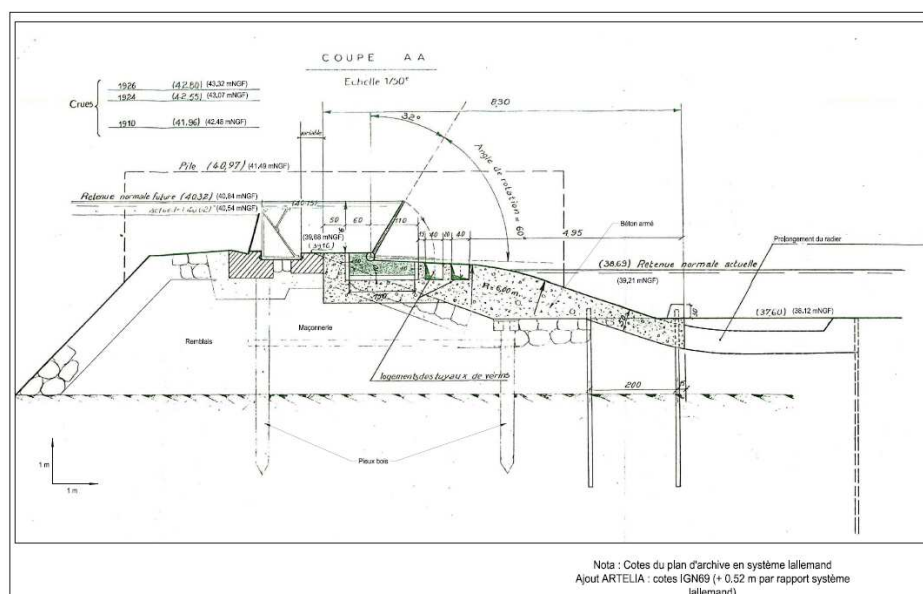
Coupe sur déversoir pour l'exécution des travaux de 1968 – Cahier de plans technique ARTELIA
